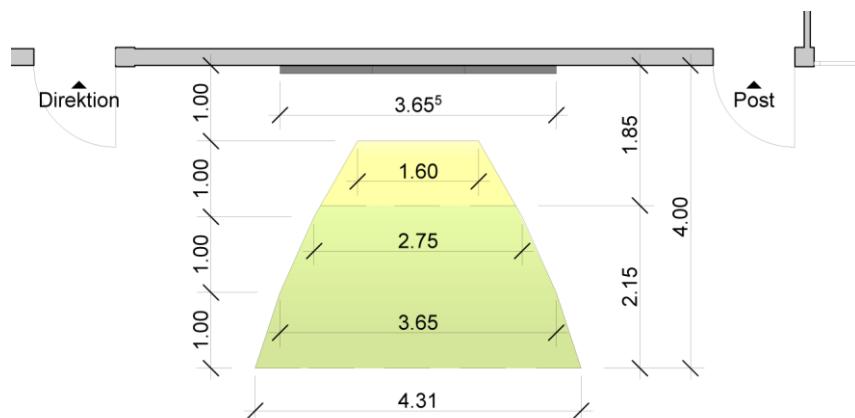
Kinect Skelett-Erkennungsbereich, Grundriss Verwaltungsgebäude
